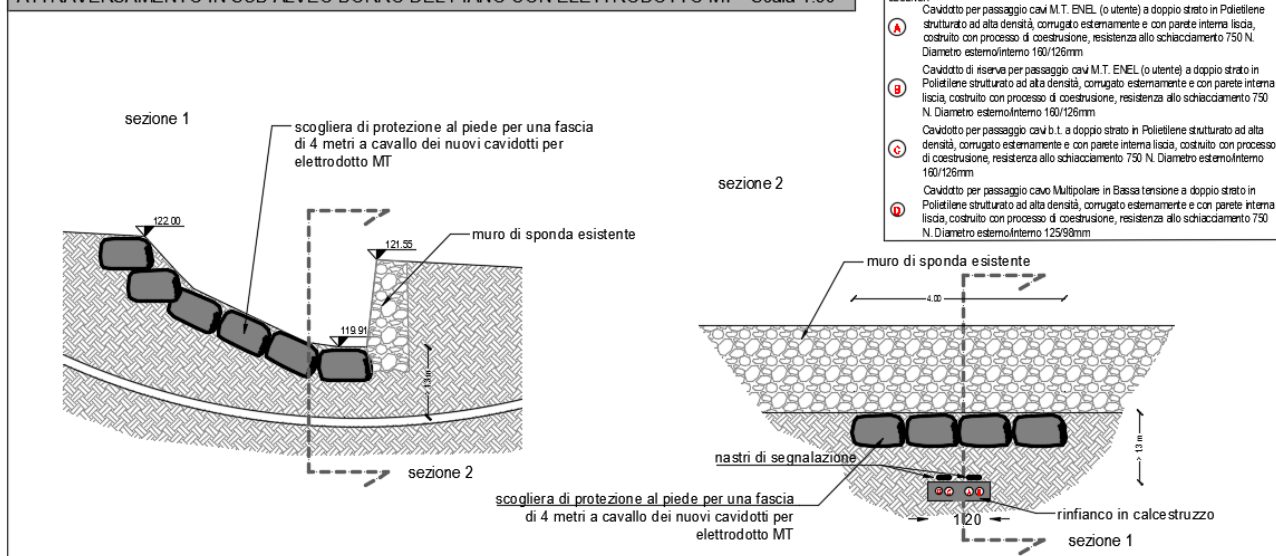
SCHEMA DELL'INTERVENTO SUL BORRO DEL PIANO
